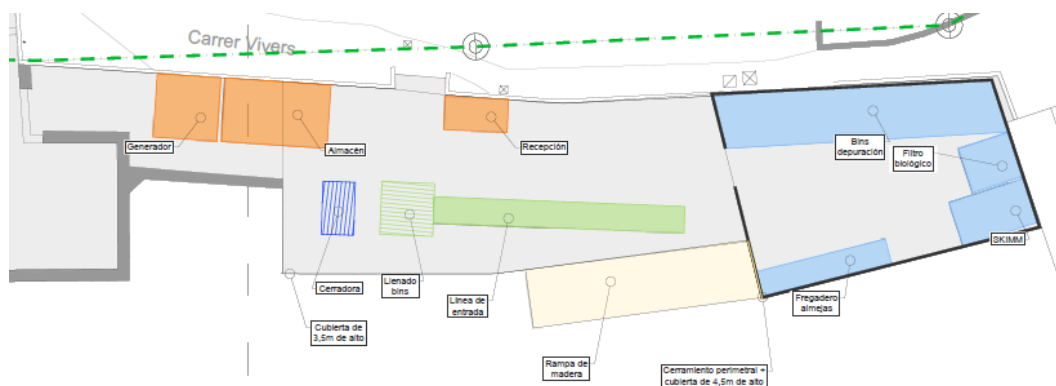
Planta propuesta para la alternativa 1 en las parcelas 8, 9 y 10.
